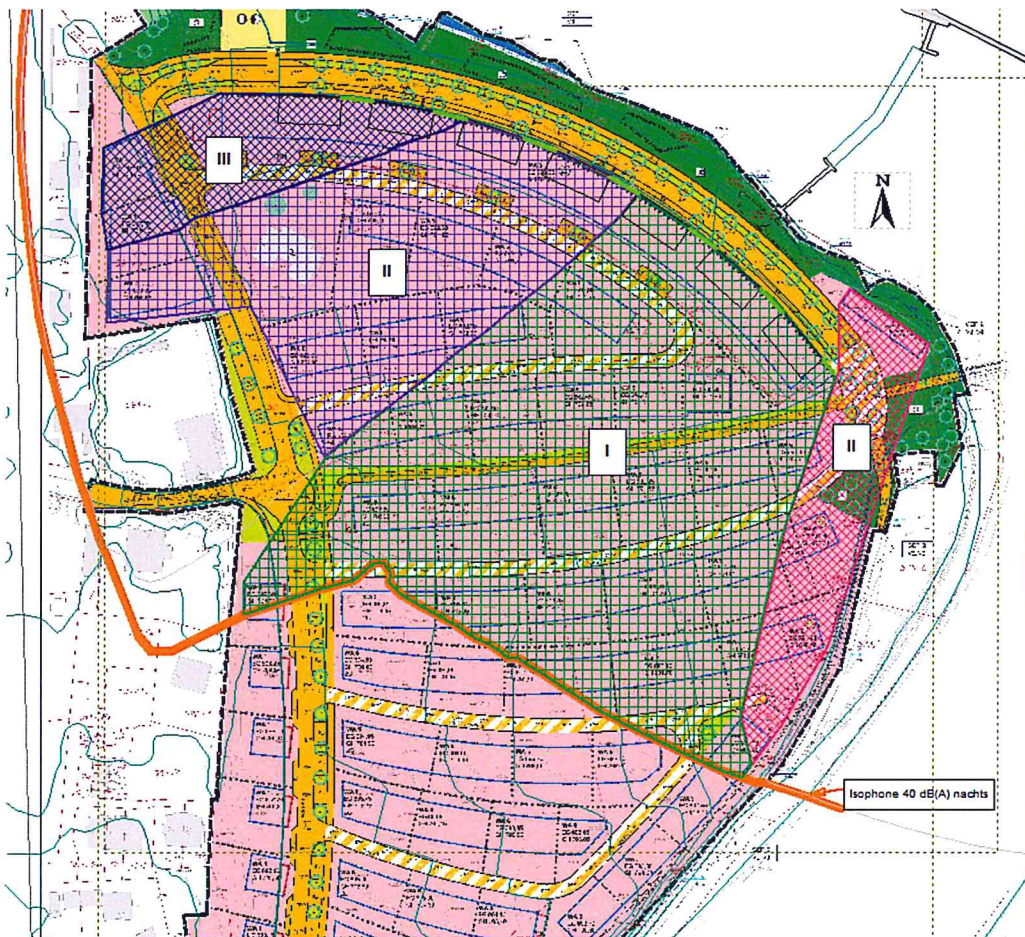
Zulässige Fertigstellungsbereiche bei abschnittweisem Bauablauf der Riegelbebauung WA 8 und WA 9
